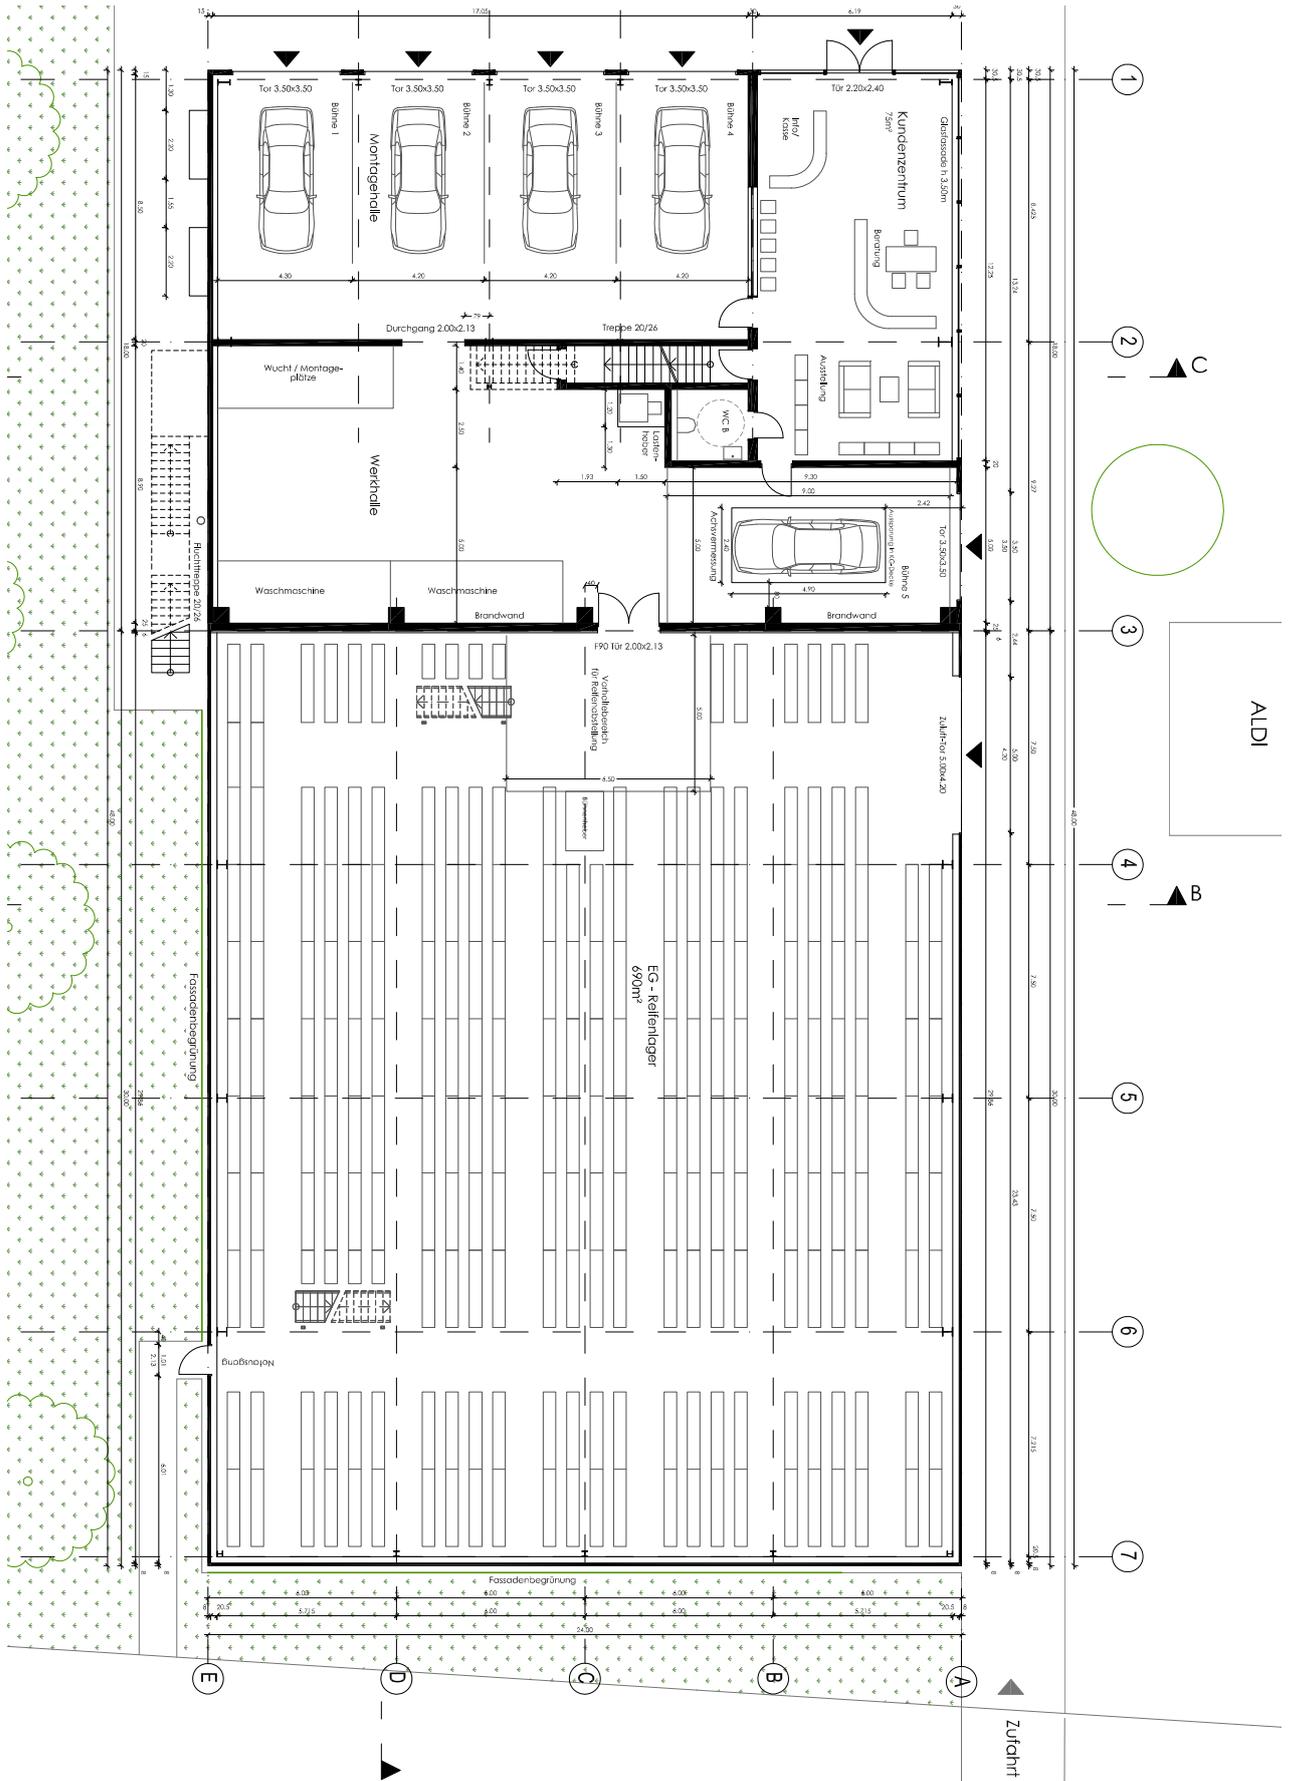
Entwurfsplanung Reifenhotel - Grundriss EG (Ausschnitt, o.M.), 19.09.2016
